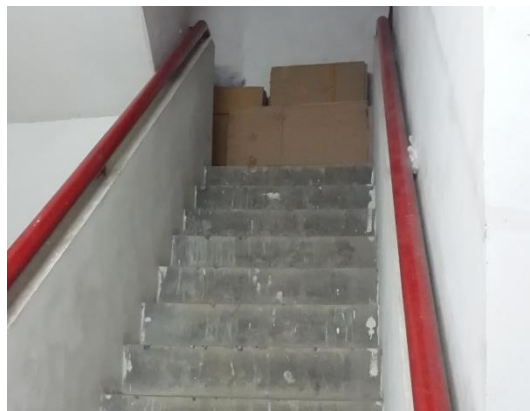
Tonjolan balok lantai pada bordes tangga darurat
